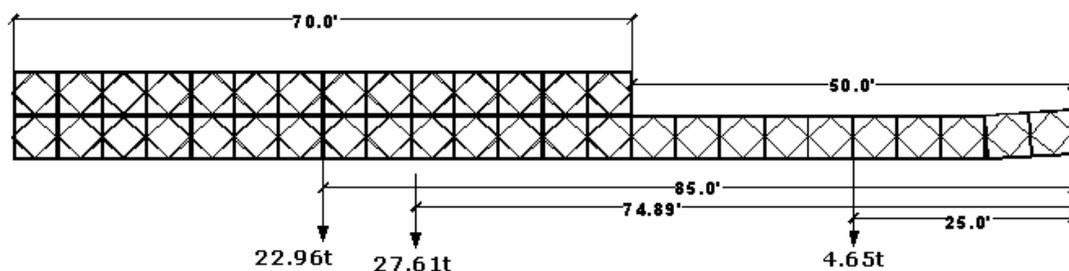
Ejemplo 4.2 Morro de lanzamiento de puente Bailey D.D.70'.M-2.
